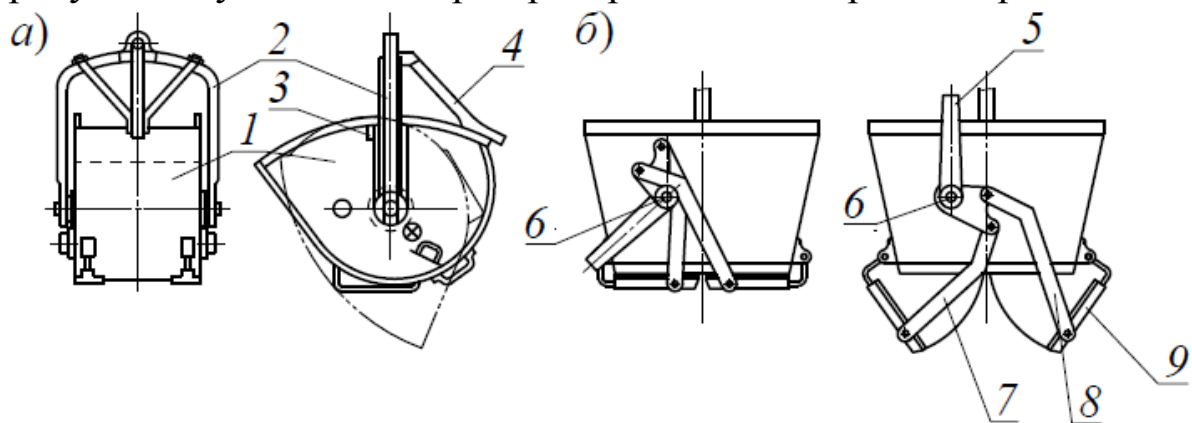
Бадьи: а – опрокидная; б – с раскрывающимся днищем
